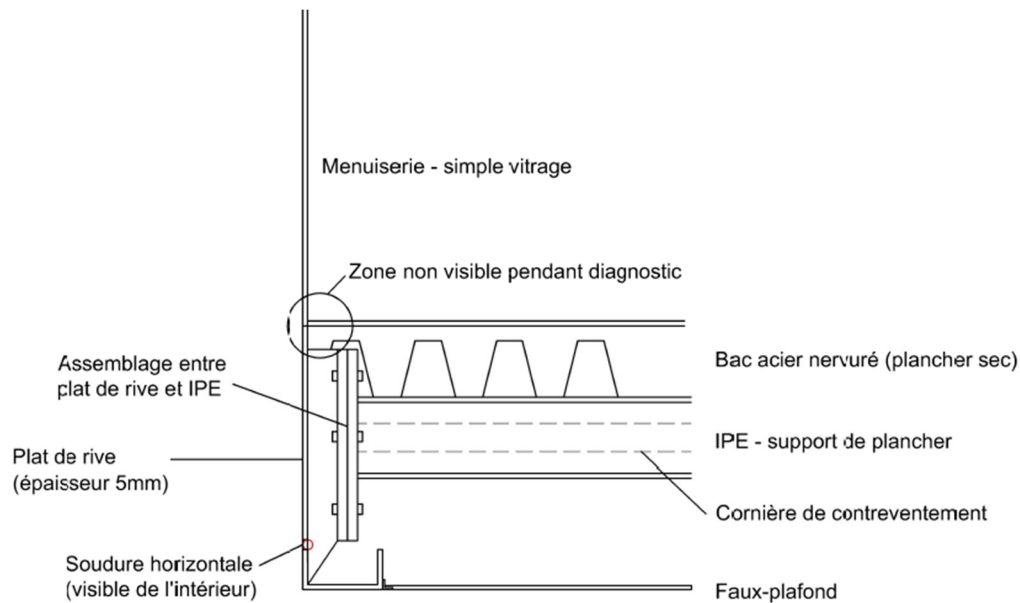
Coupe de principe liaison IPE/rive - plancher bas passerelle (sans échelle)
